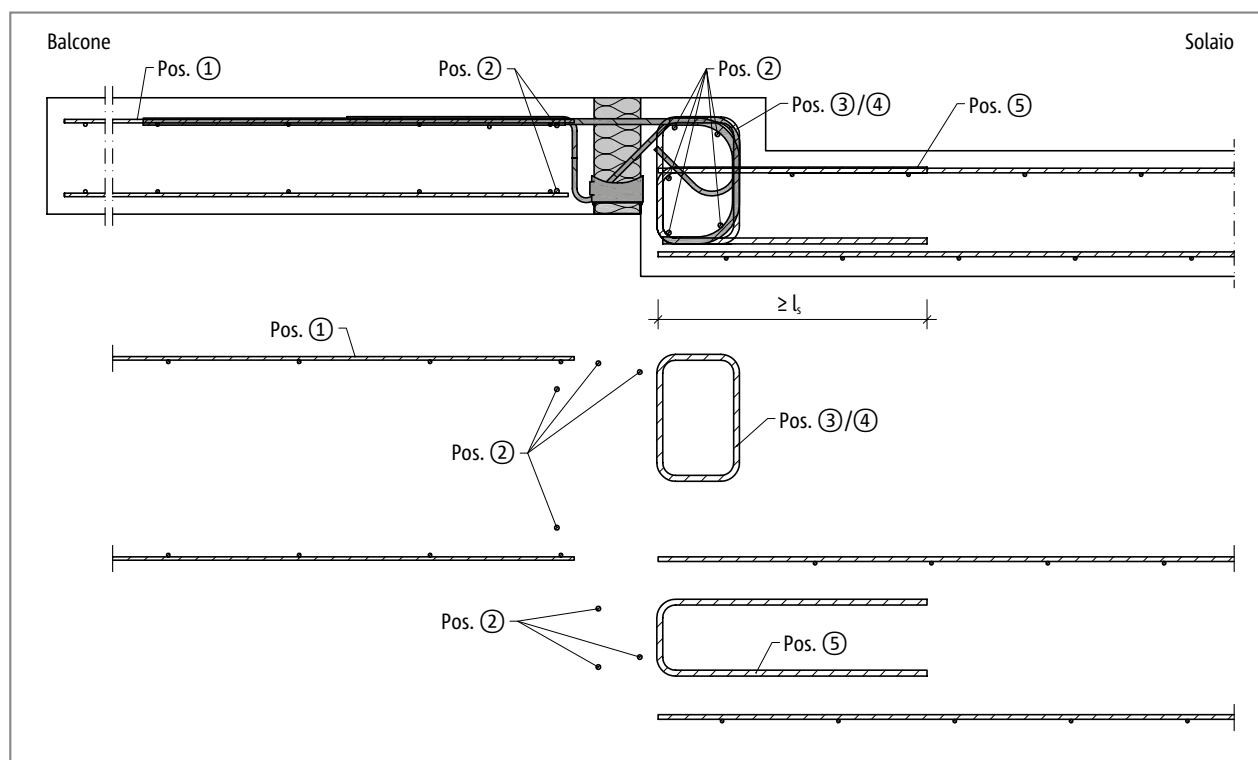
Schöck Isokorb® tipo K-UZ: Armatura in opera
